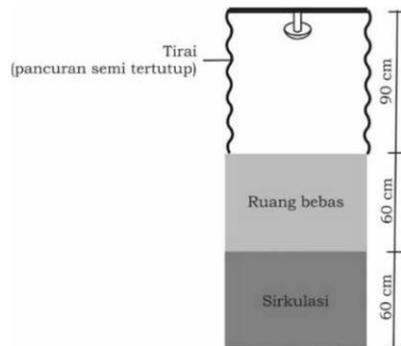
Dimensi dan ruang gerak pancuran di fasilitas publik
